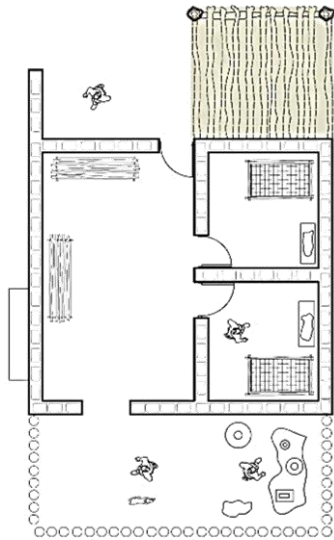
Planta Vivienda Campesina. Vestíbulo- Fuente: Elaboración propia.
